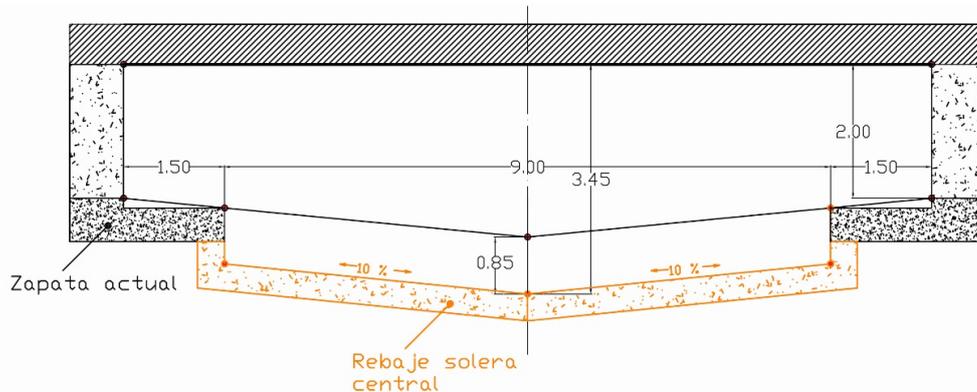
Sección tipo del canal bajo los Puentes 8 y 9.
